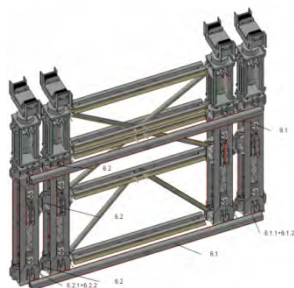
Głowica VST 100. Na zdjęciu widoczne są siłowniki hydrauliczne zamontowane w głowicach
